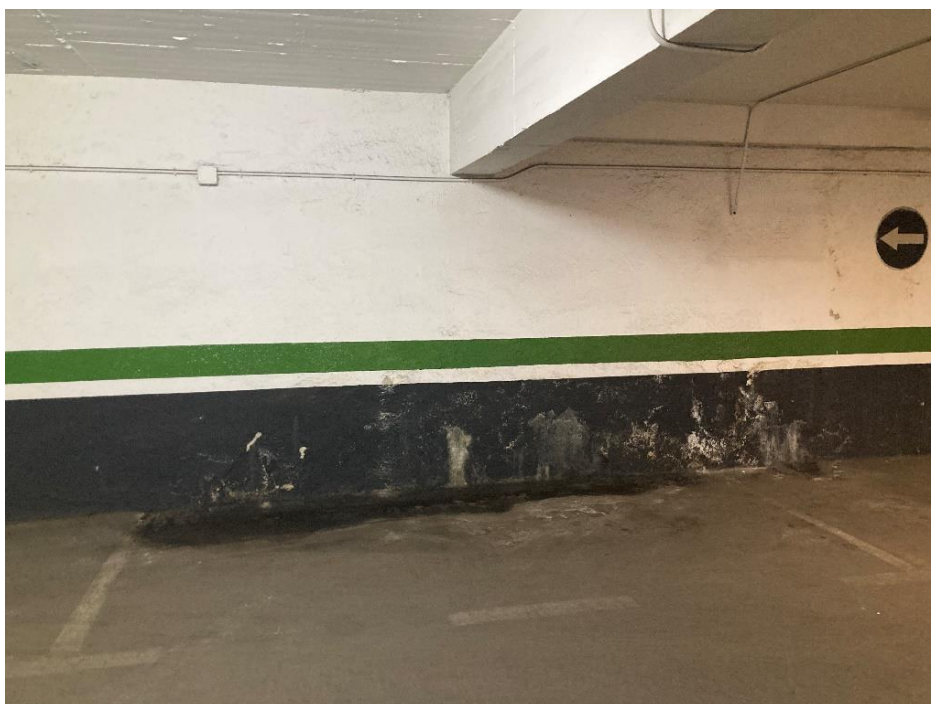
Humedades muro y forjado, zona- esquina inferior derecha, planta S-2
